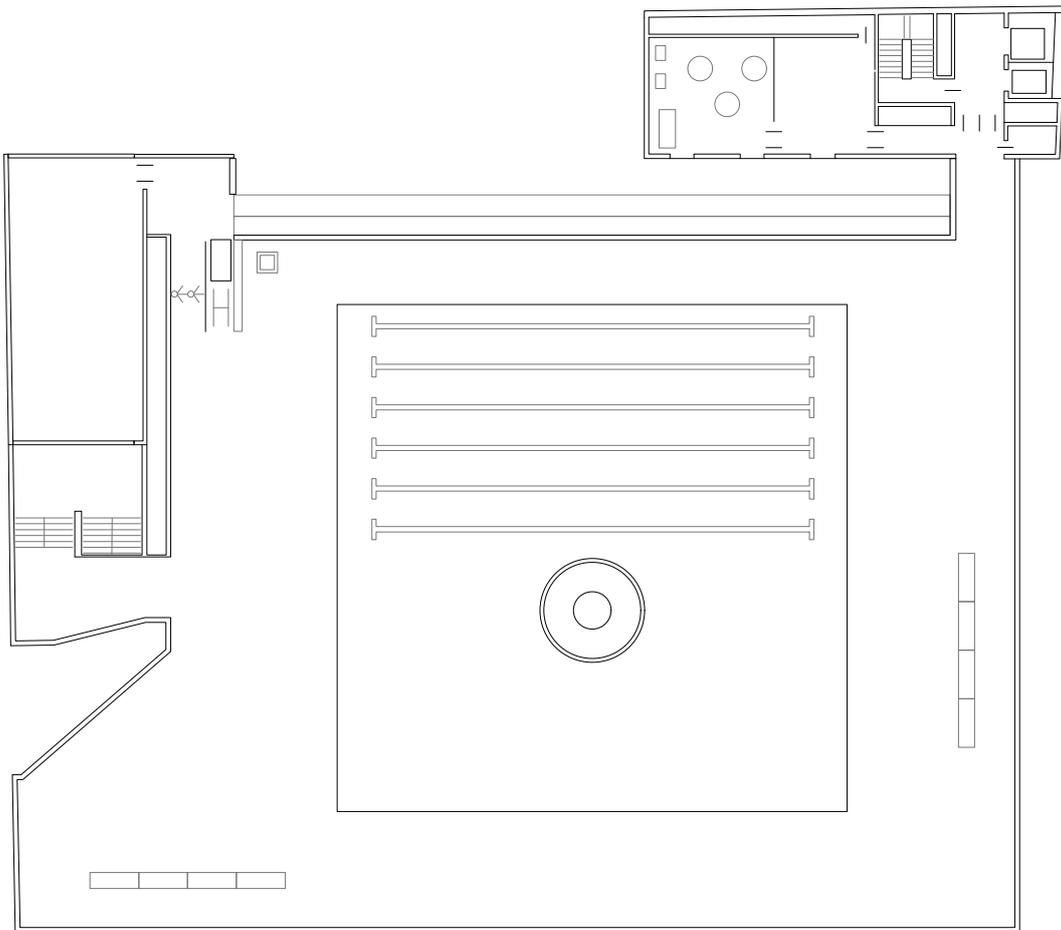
Grundriss Dachgeschoss, Sesc 24 De Maio
